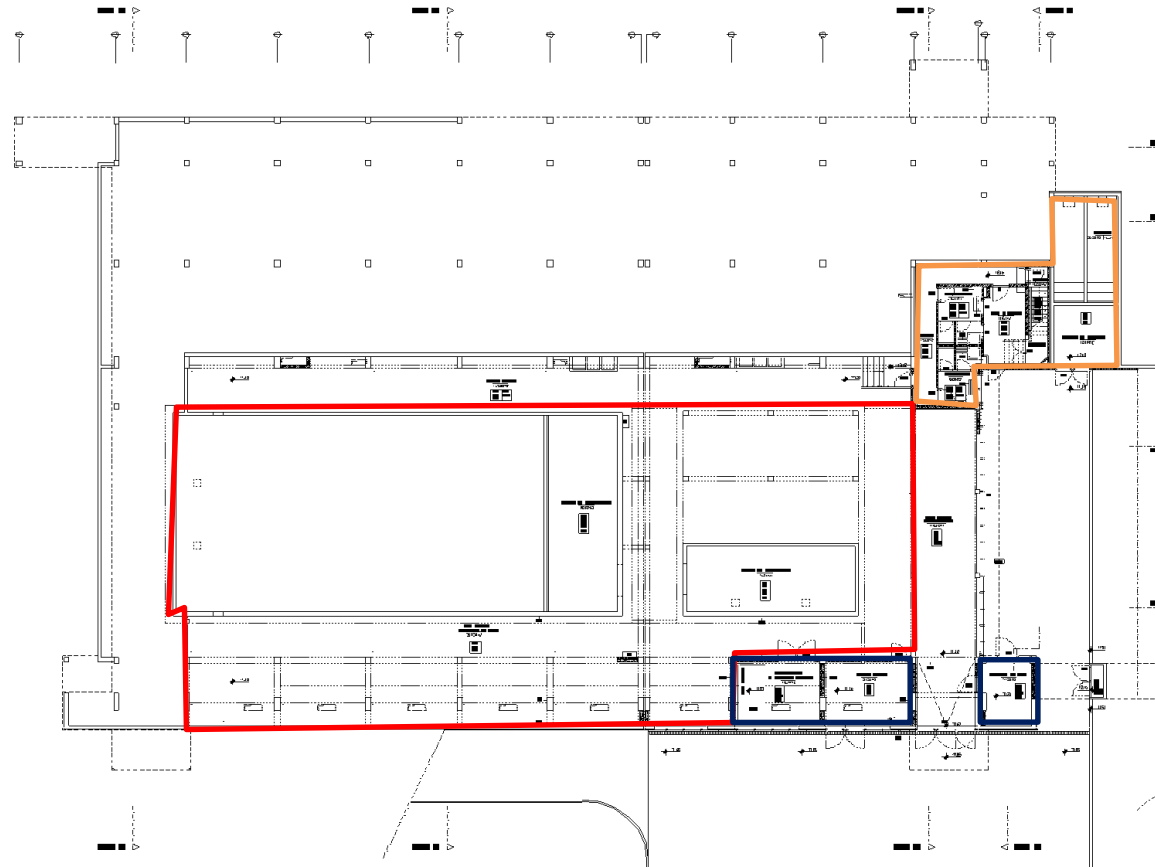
Planta Da Cave. Fonte: Projeto de arquitetura
